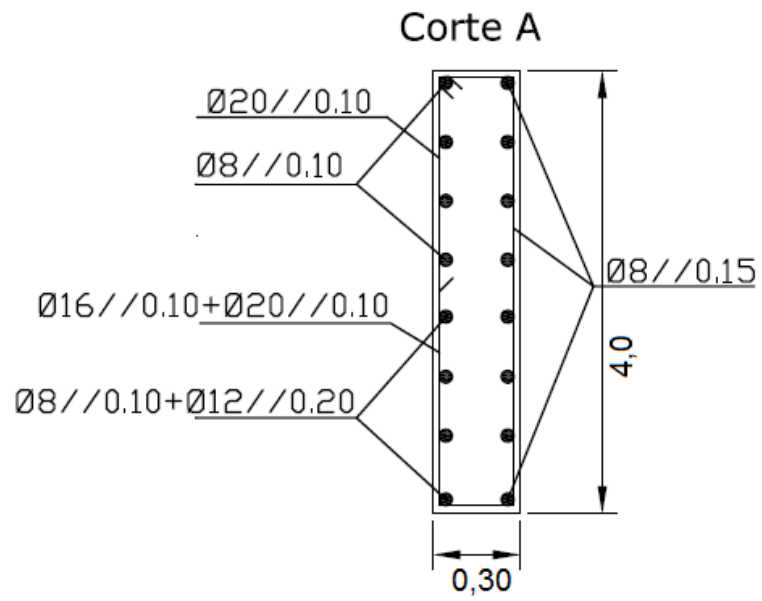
Desenho das armaduras segundo o corte transversal A.
